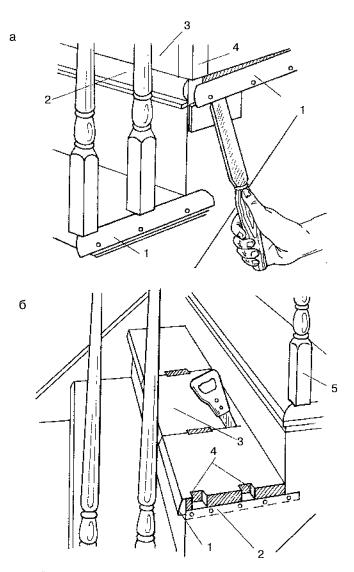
Ремонт проступи с помощью деревянной вставки: а — подготовка к ремонту: 1 — декоративный боковой валик; 2 — передний поясок; 3 — проступь; 4 — стойка перил; б — замена участка проступи: 1 — снятый боковой валик; 2 — передний поясок; 3 — вырезаемый участок проступи; 4 — пазы стоек перил; 5 — стойки перил
